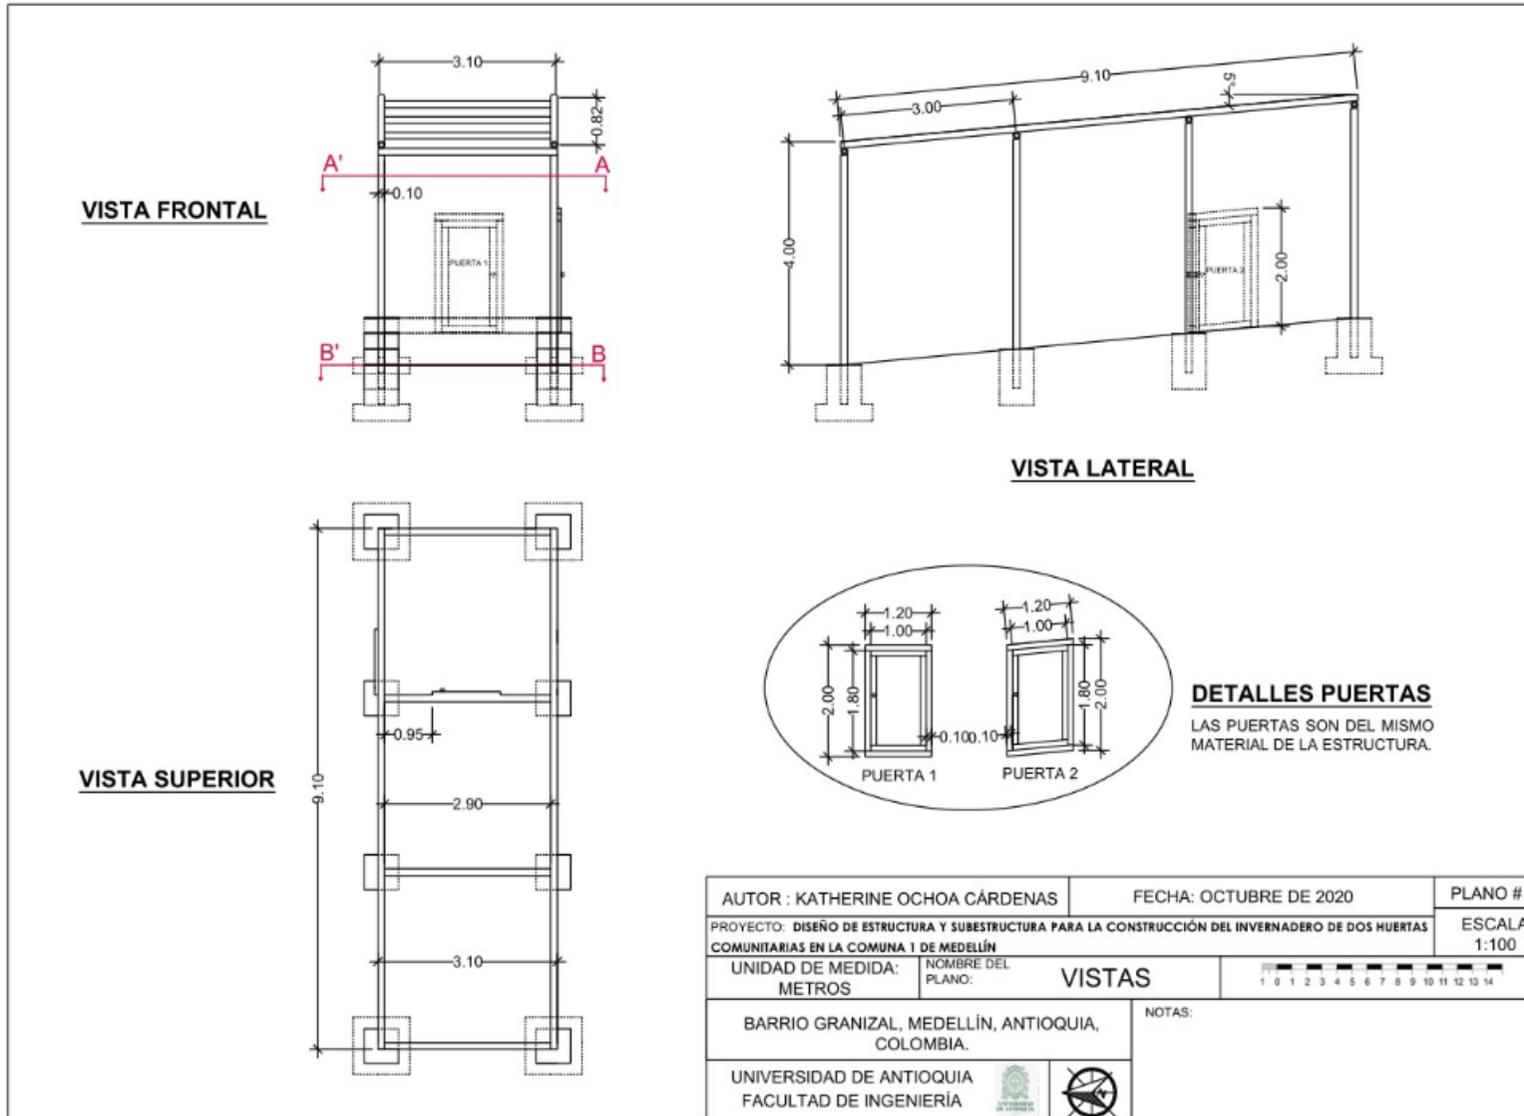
Plano #1 Vistas, Barrio Granizal.
